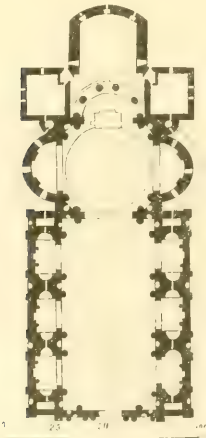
Kirche del Redentore zu Venedig. Grundriss.
